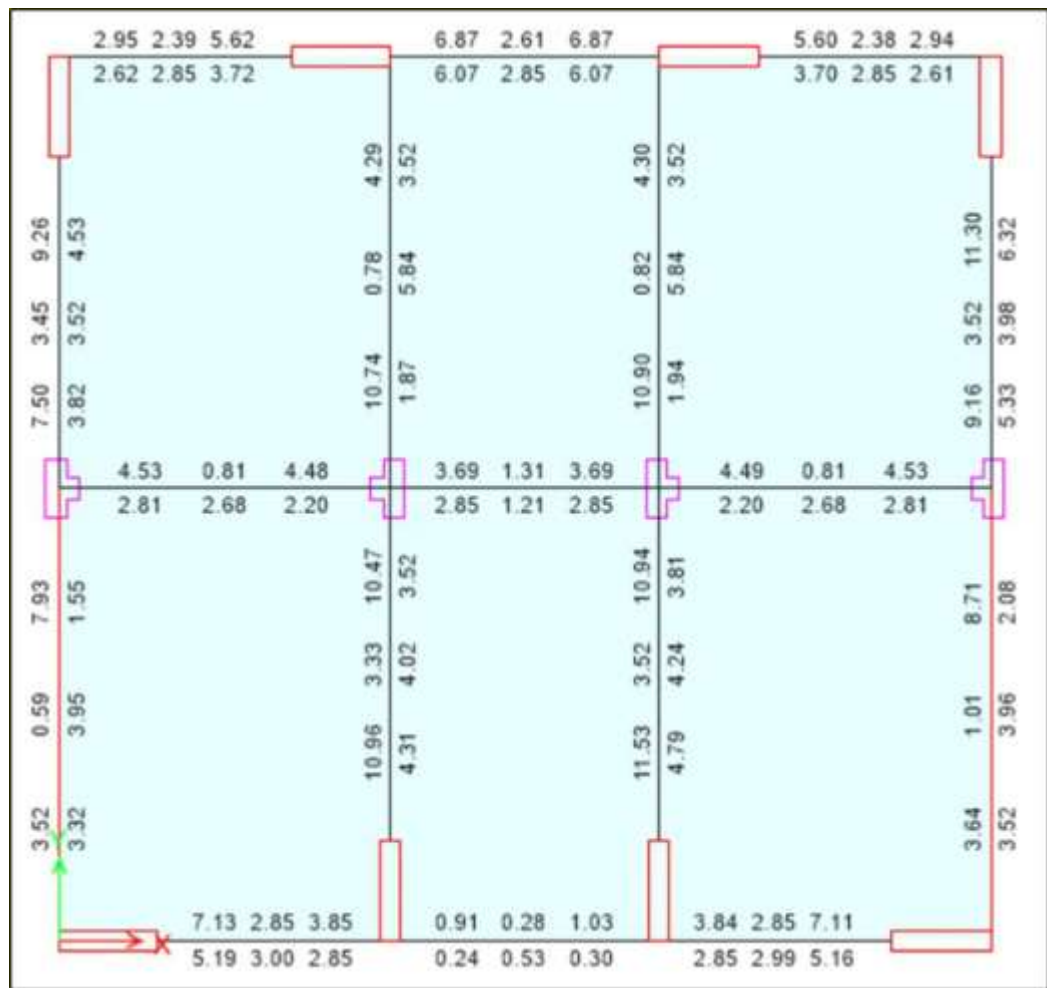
Cuantías calculadas en vigas del primer techo, Modulo C
